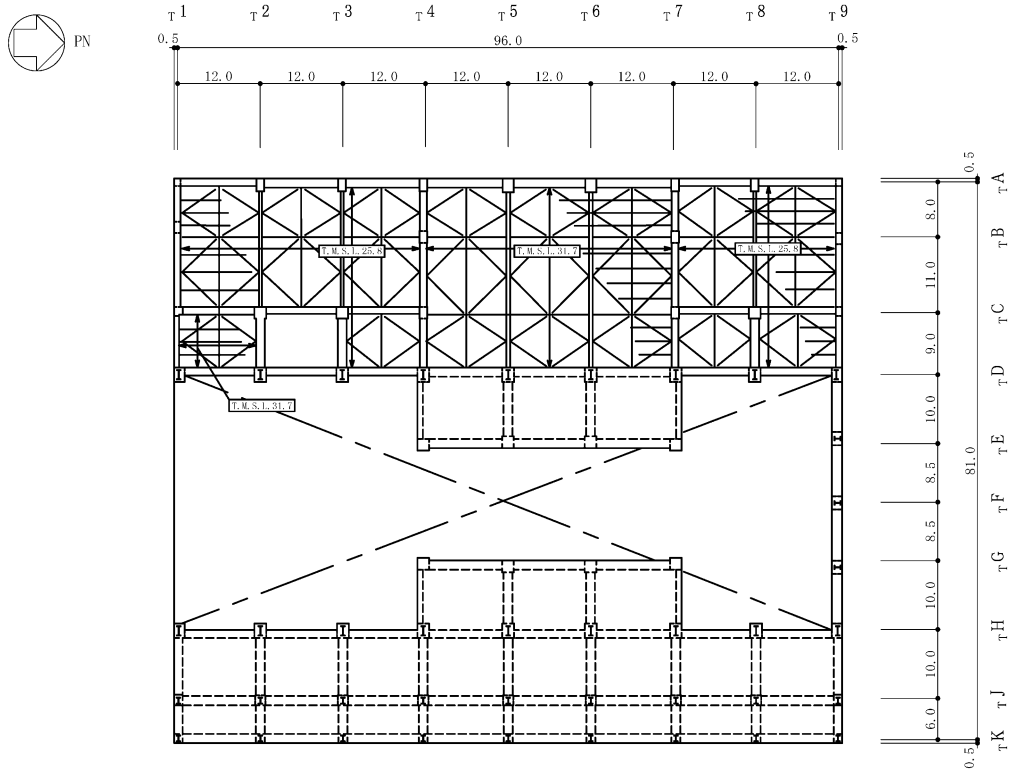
タービン建屋の概略平面図 (3F, T.M.S.L. 30.9m) (5/6) (単位 : m)
